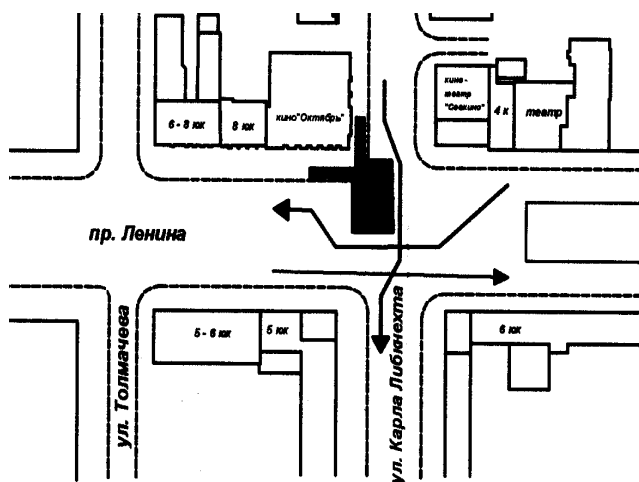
Организация уличного движения в ходе строительства мостового перекрытия подземного перехода
